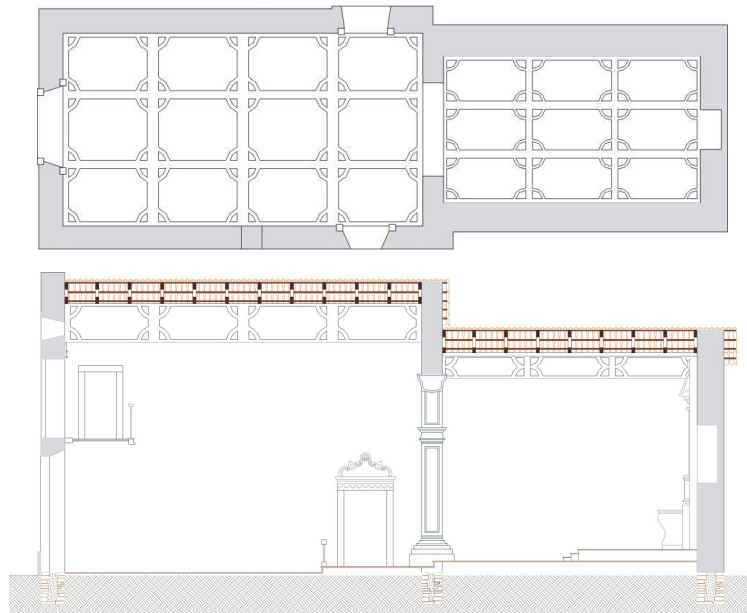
Planta Baixa e Corte mostrando detalhe do forro
